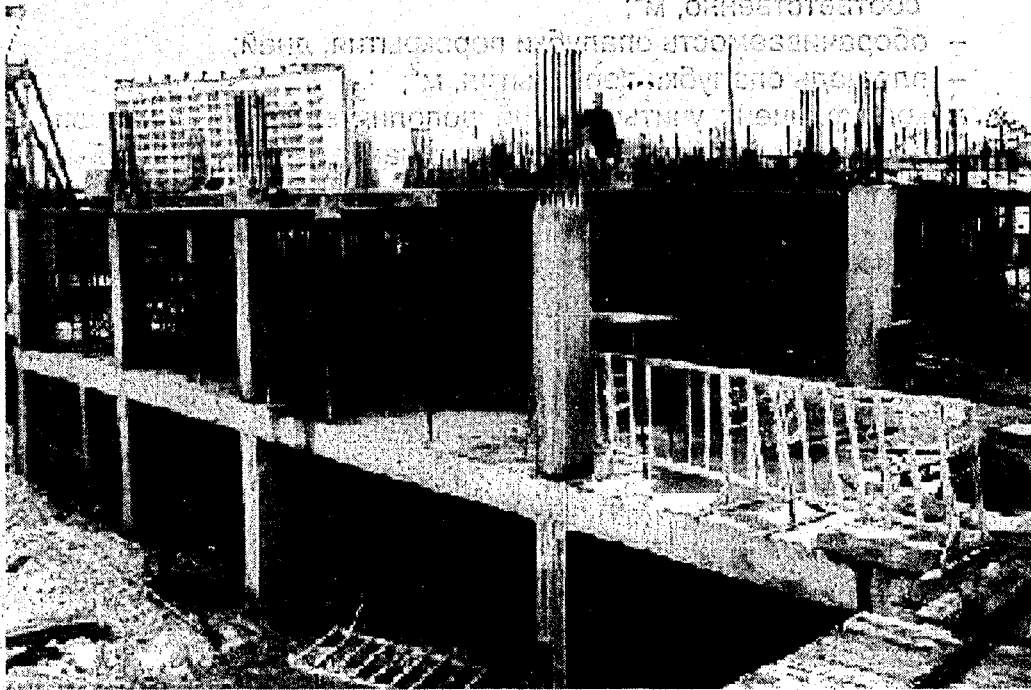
Опалубка перекрытий из опорных башен МОДОСТР на строительстве жилого дома по ул. Белорусской в г. Минске.
